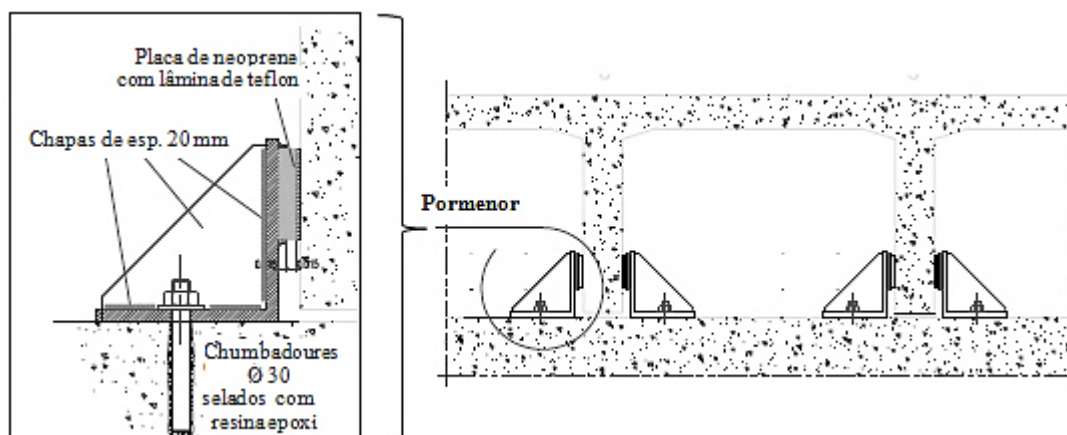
Pormenor do travamento transversal (adaptado de Brisa, 2002b).
